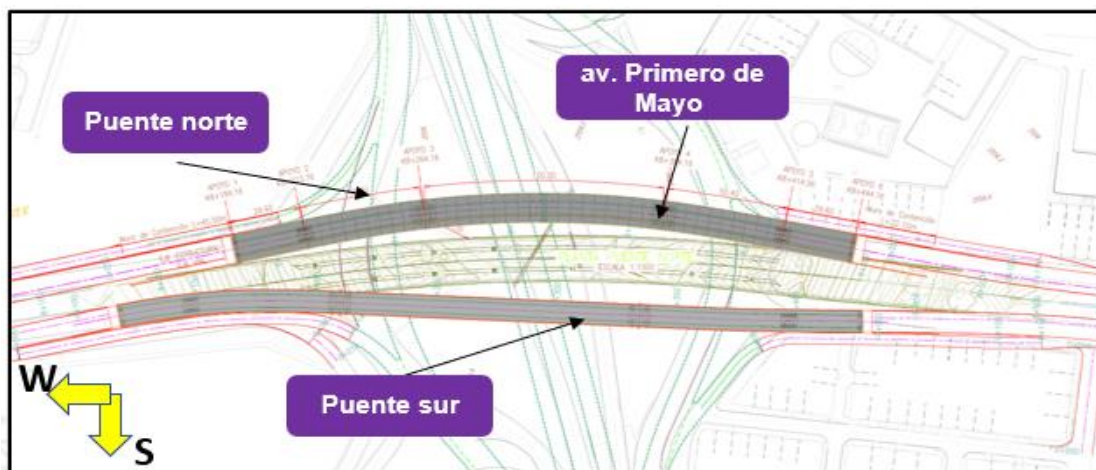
Planta general de la Intersección vial de Av. 68 con Av. 1ro de mayo
